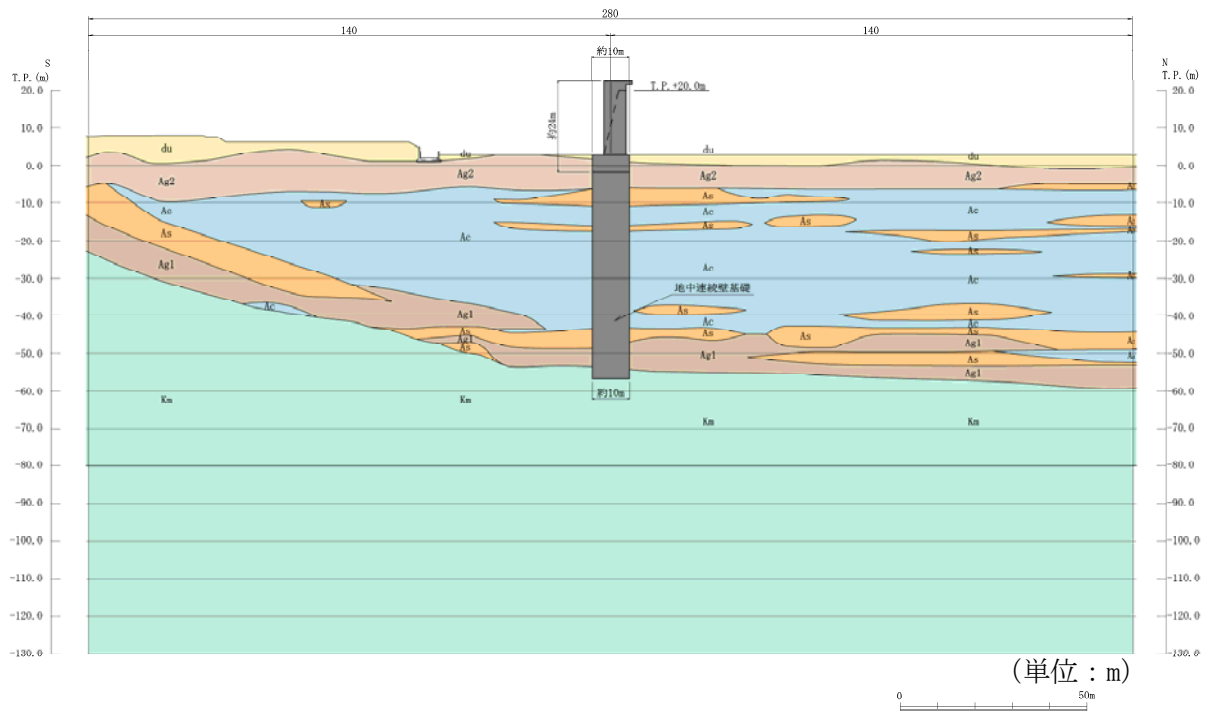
(7) 鉄筋コンクリート防潮壁 断面図(G-G断面)
